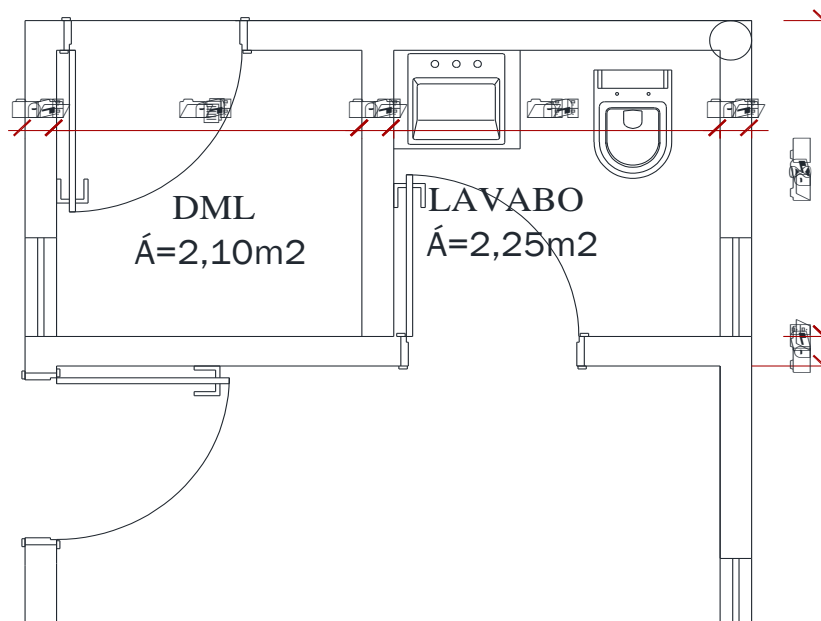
Planta baixa do novo banheiro Coordenação e Diretoria
